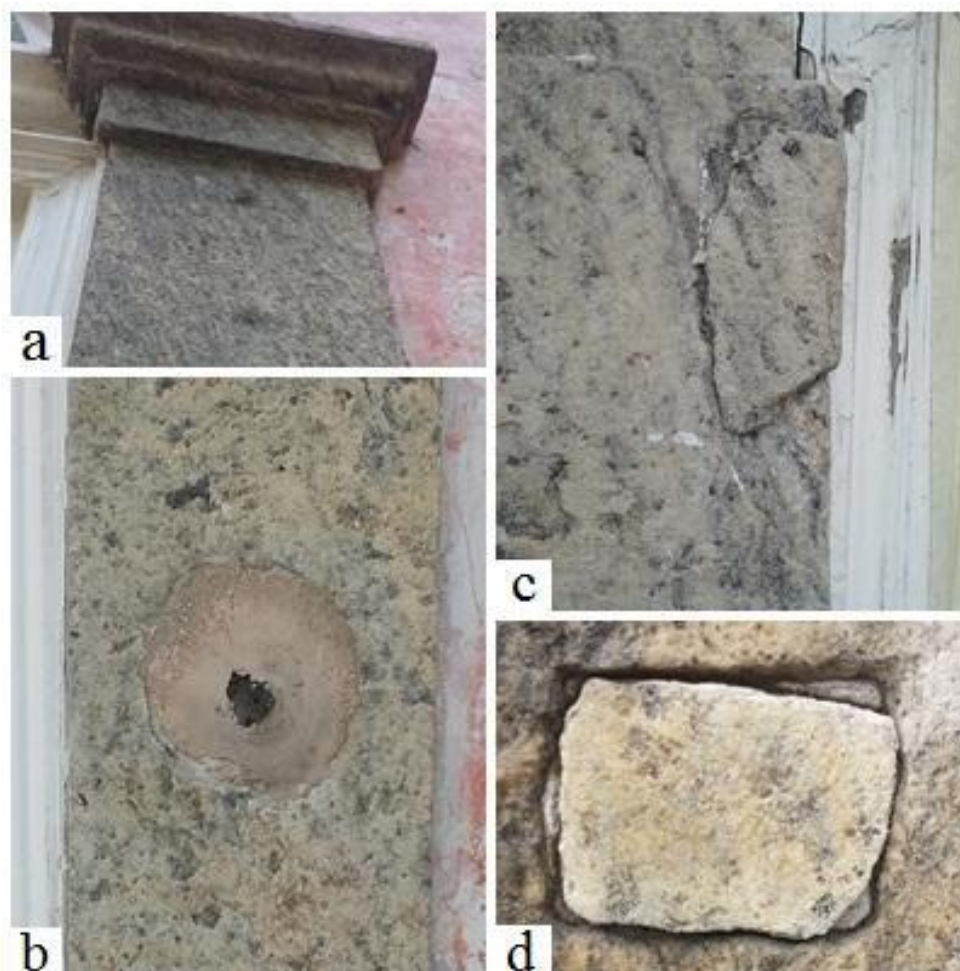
Exemplos de modificação de elementos da fachada. a) e b) Marcas de remoção de elementos da fachada; c) e d) Colagem de peças exóticas.
